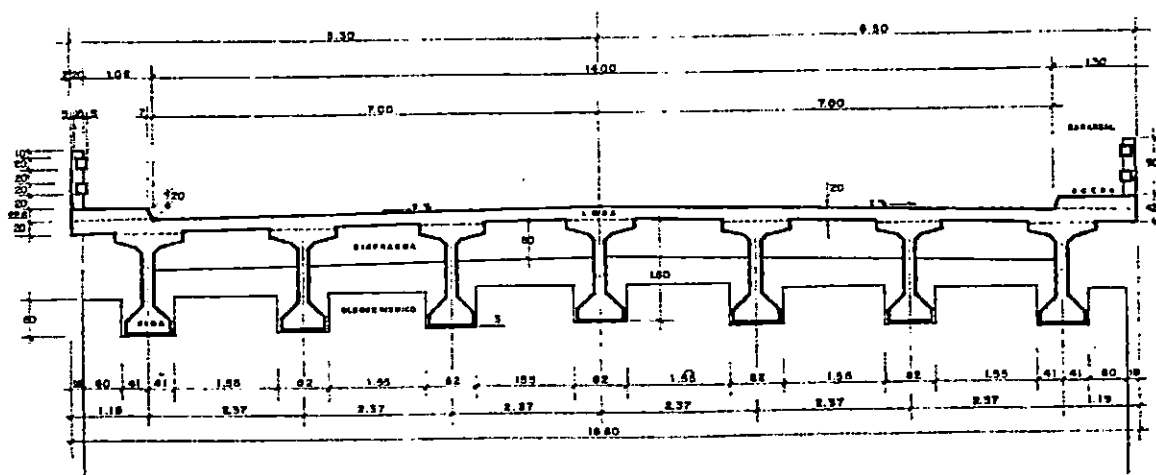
SECCION TRANSVERSAL DEL PUENTE.
